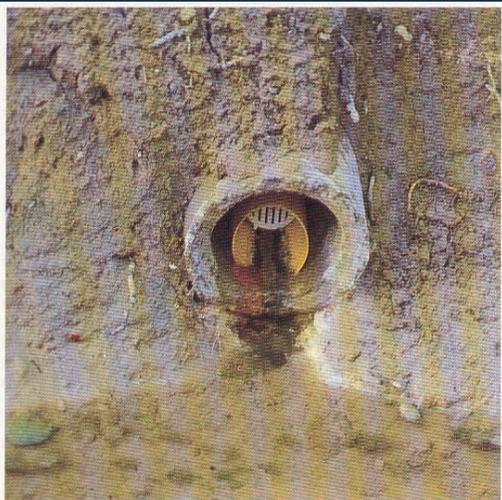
Terminale di sbocco con valvola protetto da un manufatto cementizio.
